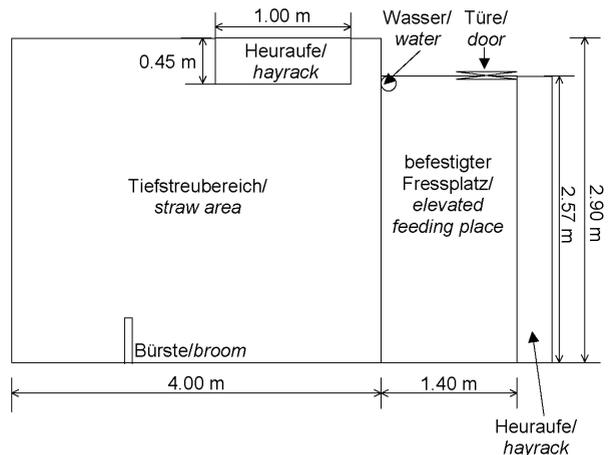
Grundriß einer Bucht ohne Strukturelemente (nicht maßstabsgetreu)
